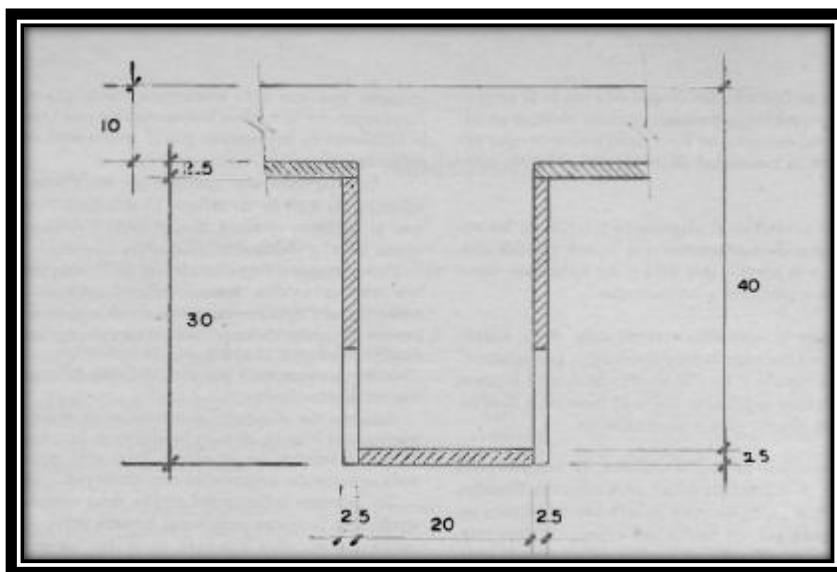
Dimensiones de tablas para encofrado de vigas
